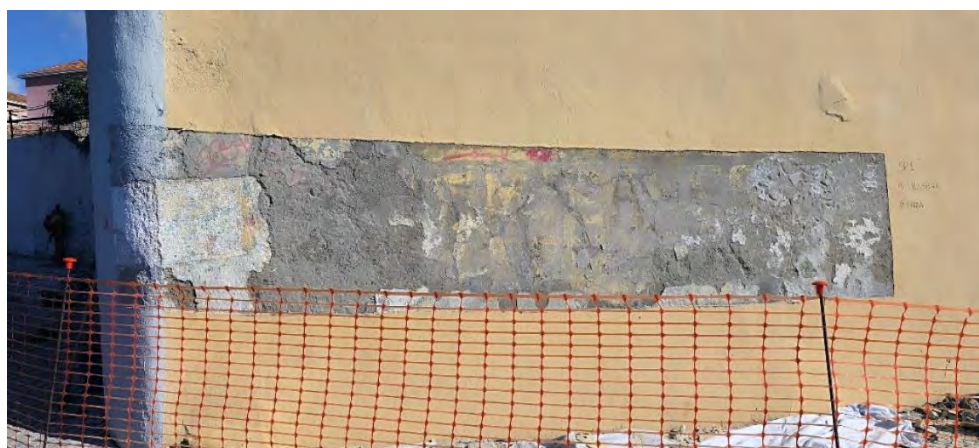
SP1 após levantamento das camadas de tinta superficiais.
